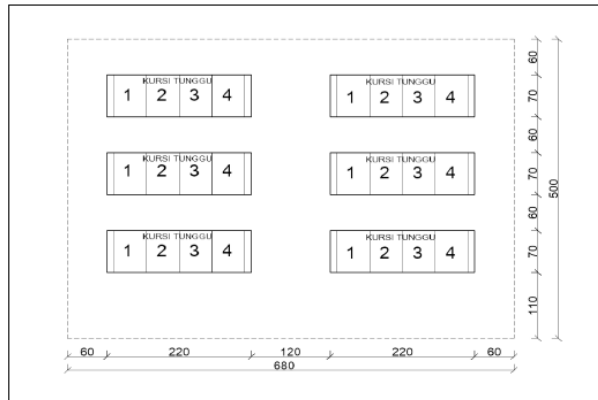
18 Tipikal Denah Ruang Kantor Pengelola
